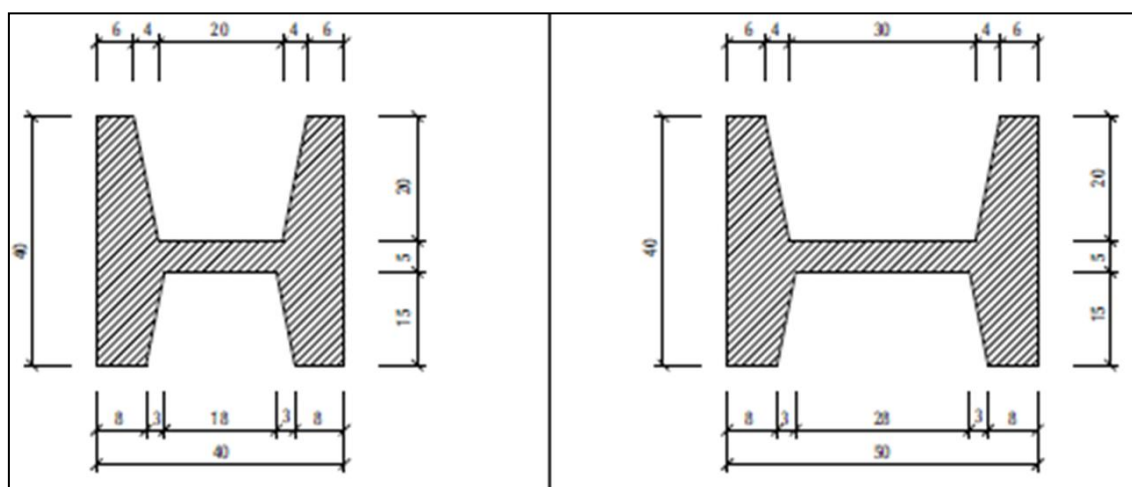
Tipos de viga H (CH40 e CH 50 respectivamente)
